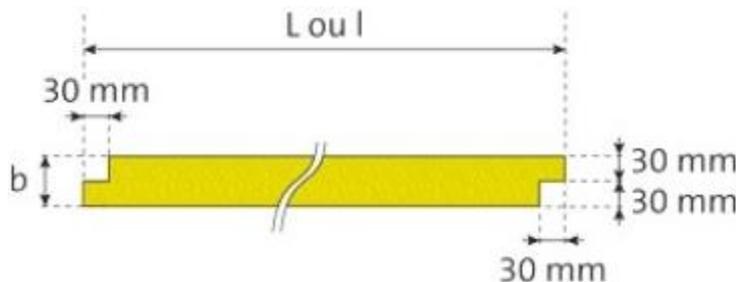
bis – Exemple d'une coupe sur panneau PROTECT LR (B ou C) d'épaisseur 60 mm
